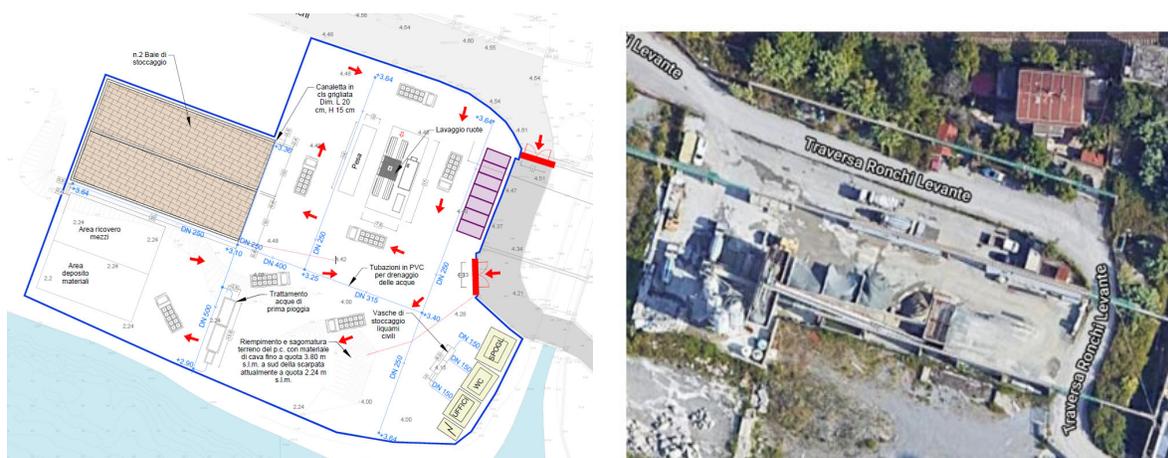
Area C4 – Layout di cantiere ed inquadramento territoriale
